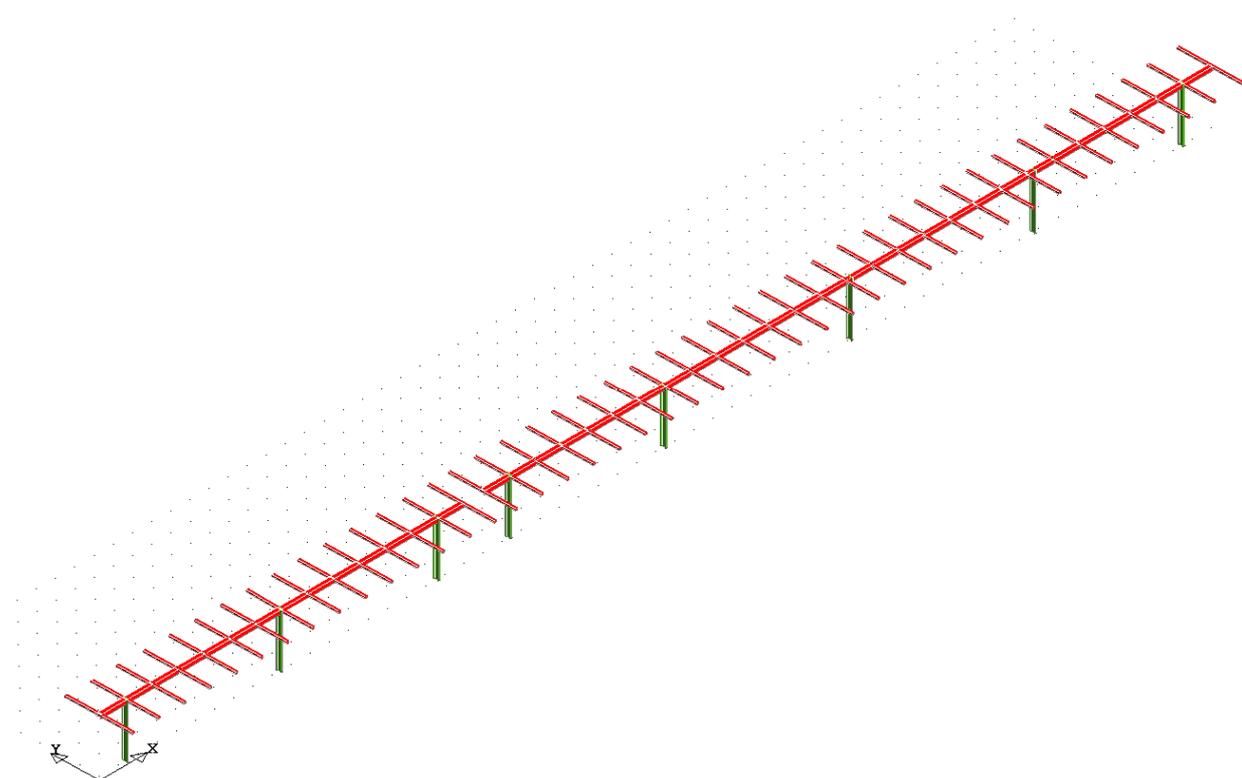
Vista assonometrica modello strutturale con posizione delle “vele” orizzontale
